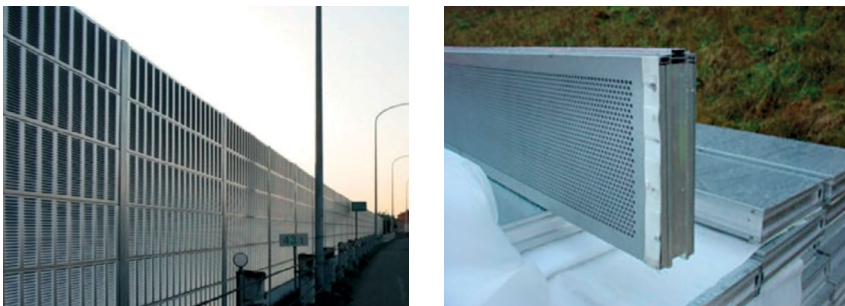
Barreira absorvente em painéis metálicos ranhurados e lâ de vidro (JH - Japan Highway Public Corporation).
